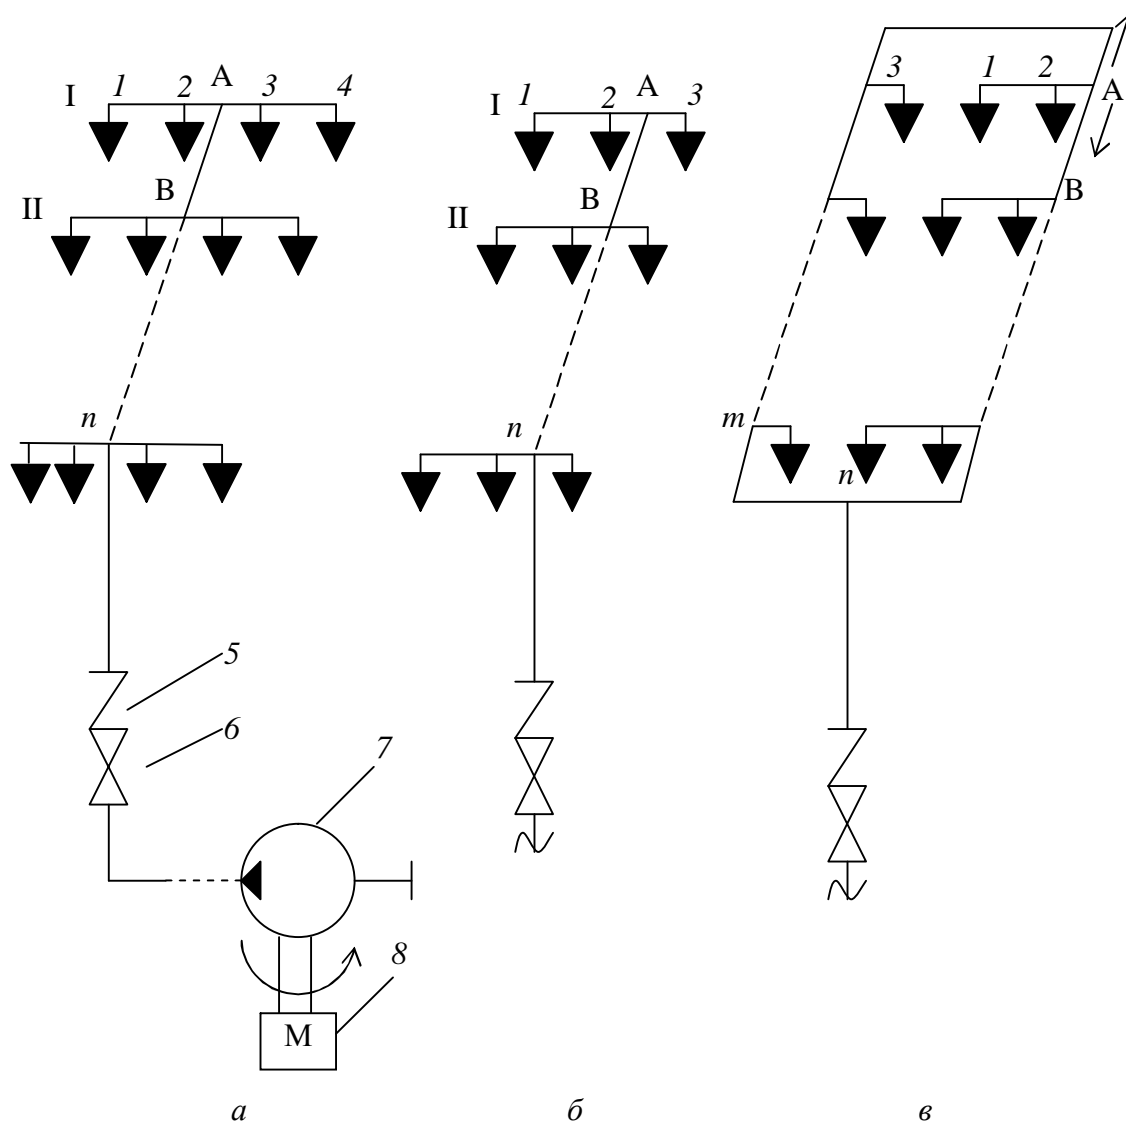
Расчетные схемы водяных установок пожаротушения:
